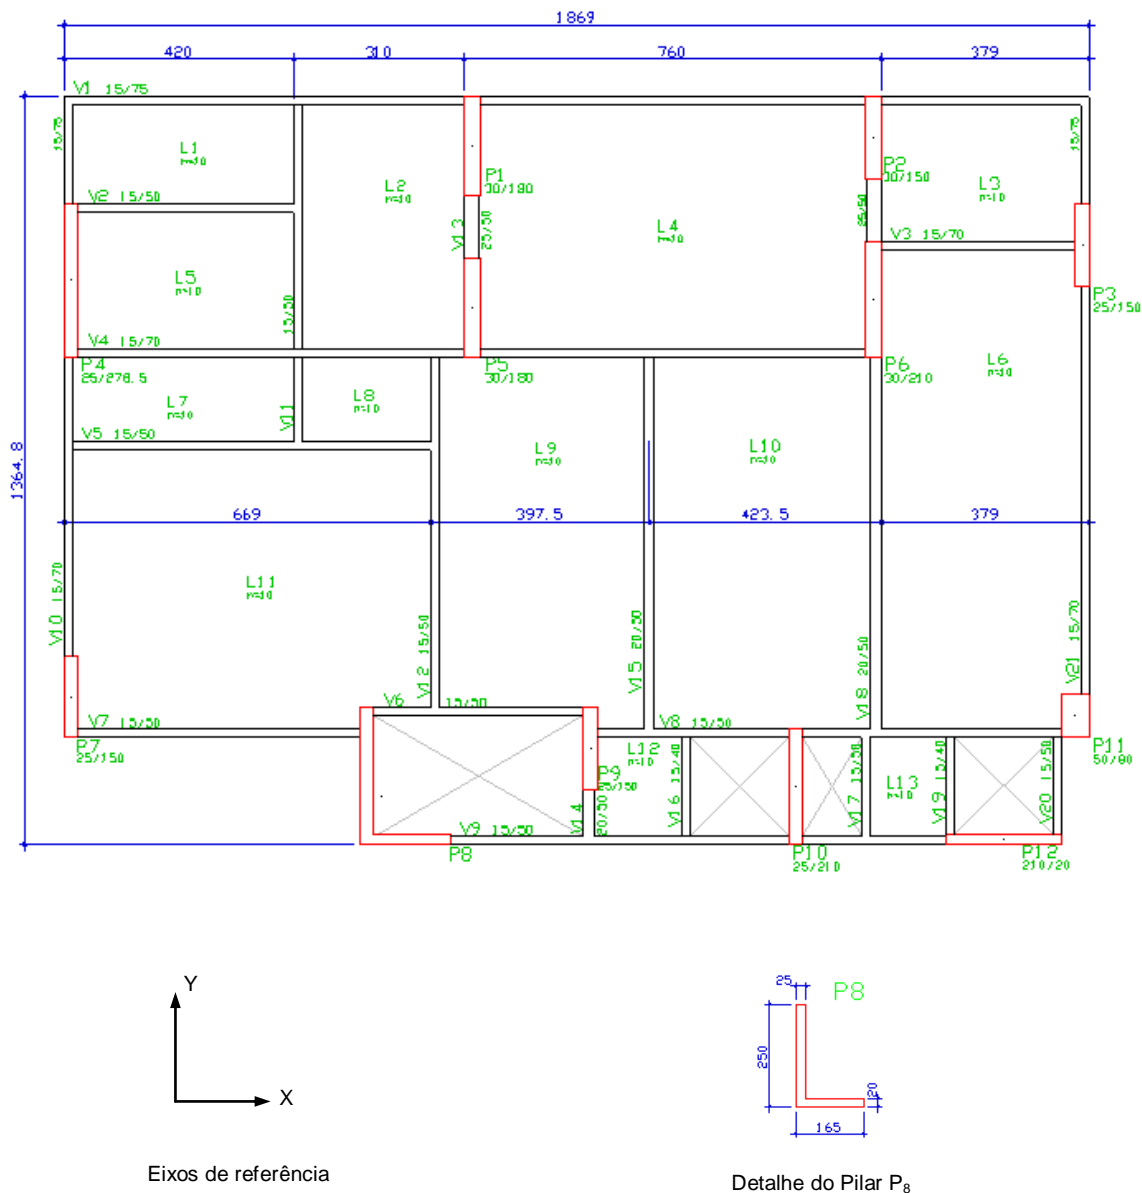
Planta baixa de forma do pavimento-tipo – Edifício 1
